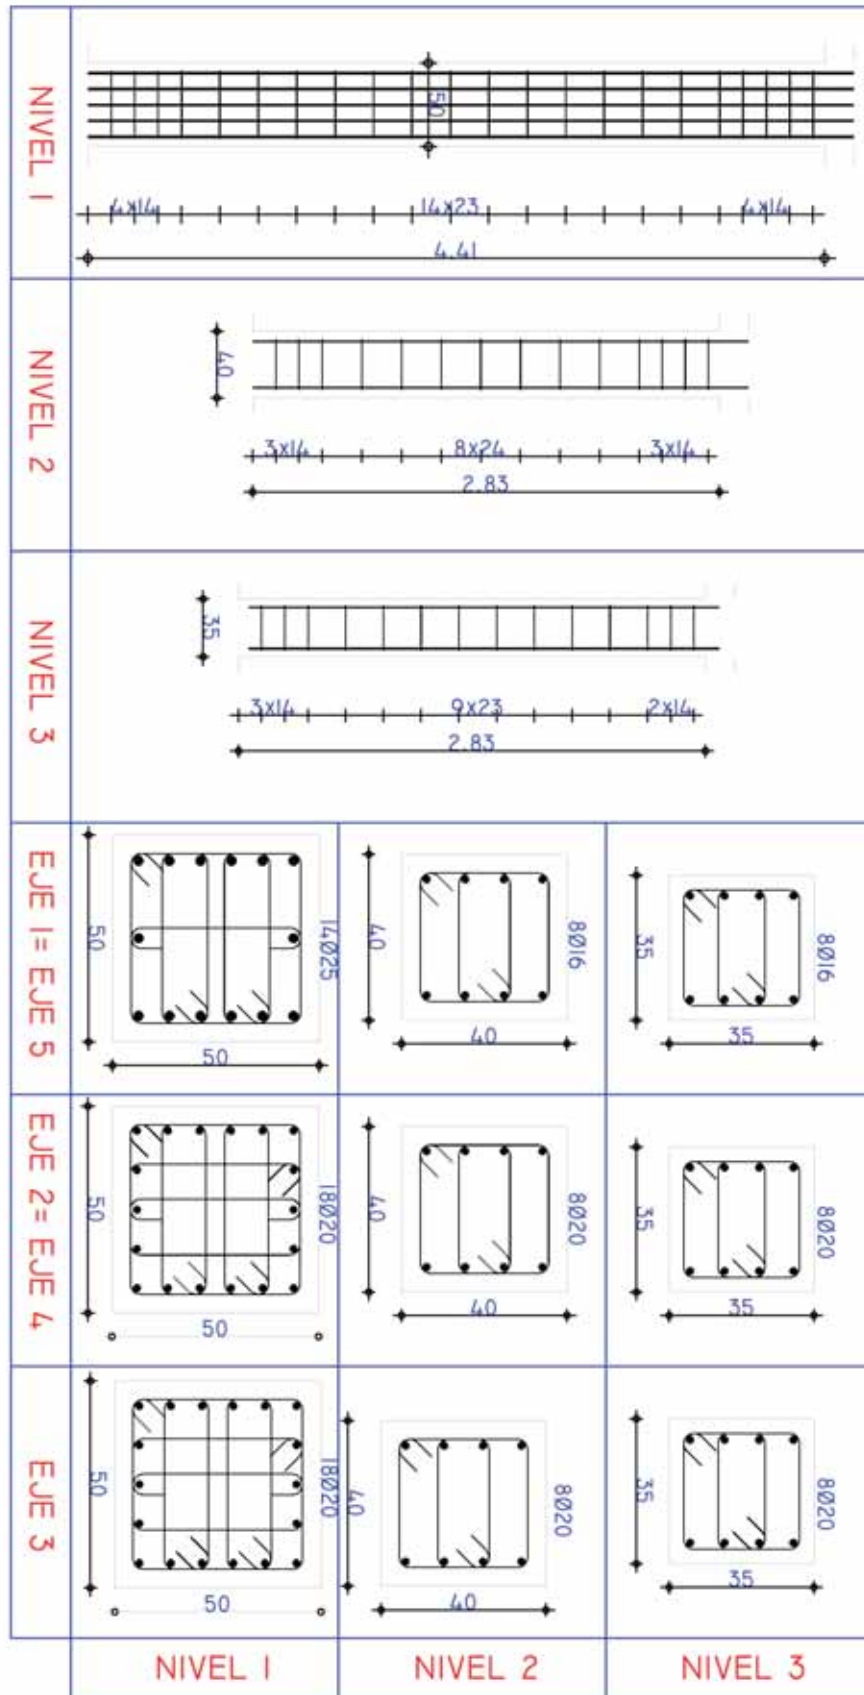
Detalles de armado de los pilares del pórtico exterior, eje 3.
